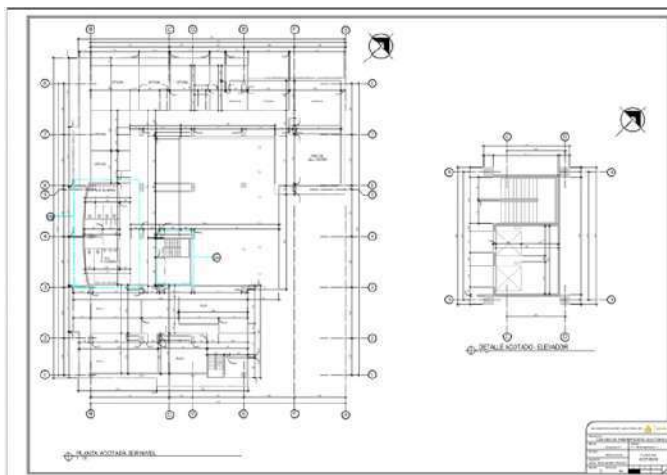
Ejemplo de plano de plantas acotadas trabajados para la entrega de planos de arquitectura del proyecto Edificio de Colegio de Ingenieros, solicitados en la asignatura de Práctica Integrada I. Elaborado por Melanie Orozco. Guatemala, octubre de 2017.
